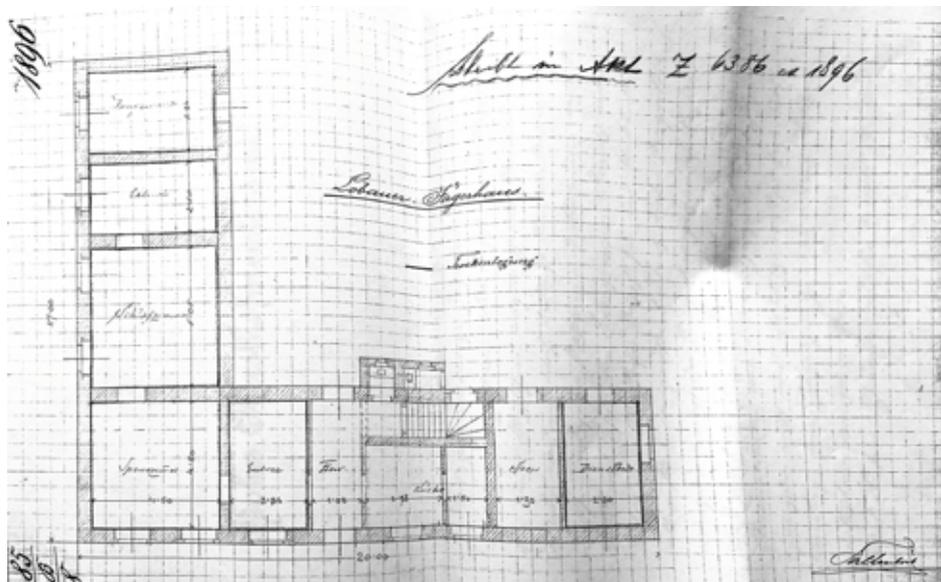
Planauszug mit Grundriss des Hofjägerhauses 1896
